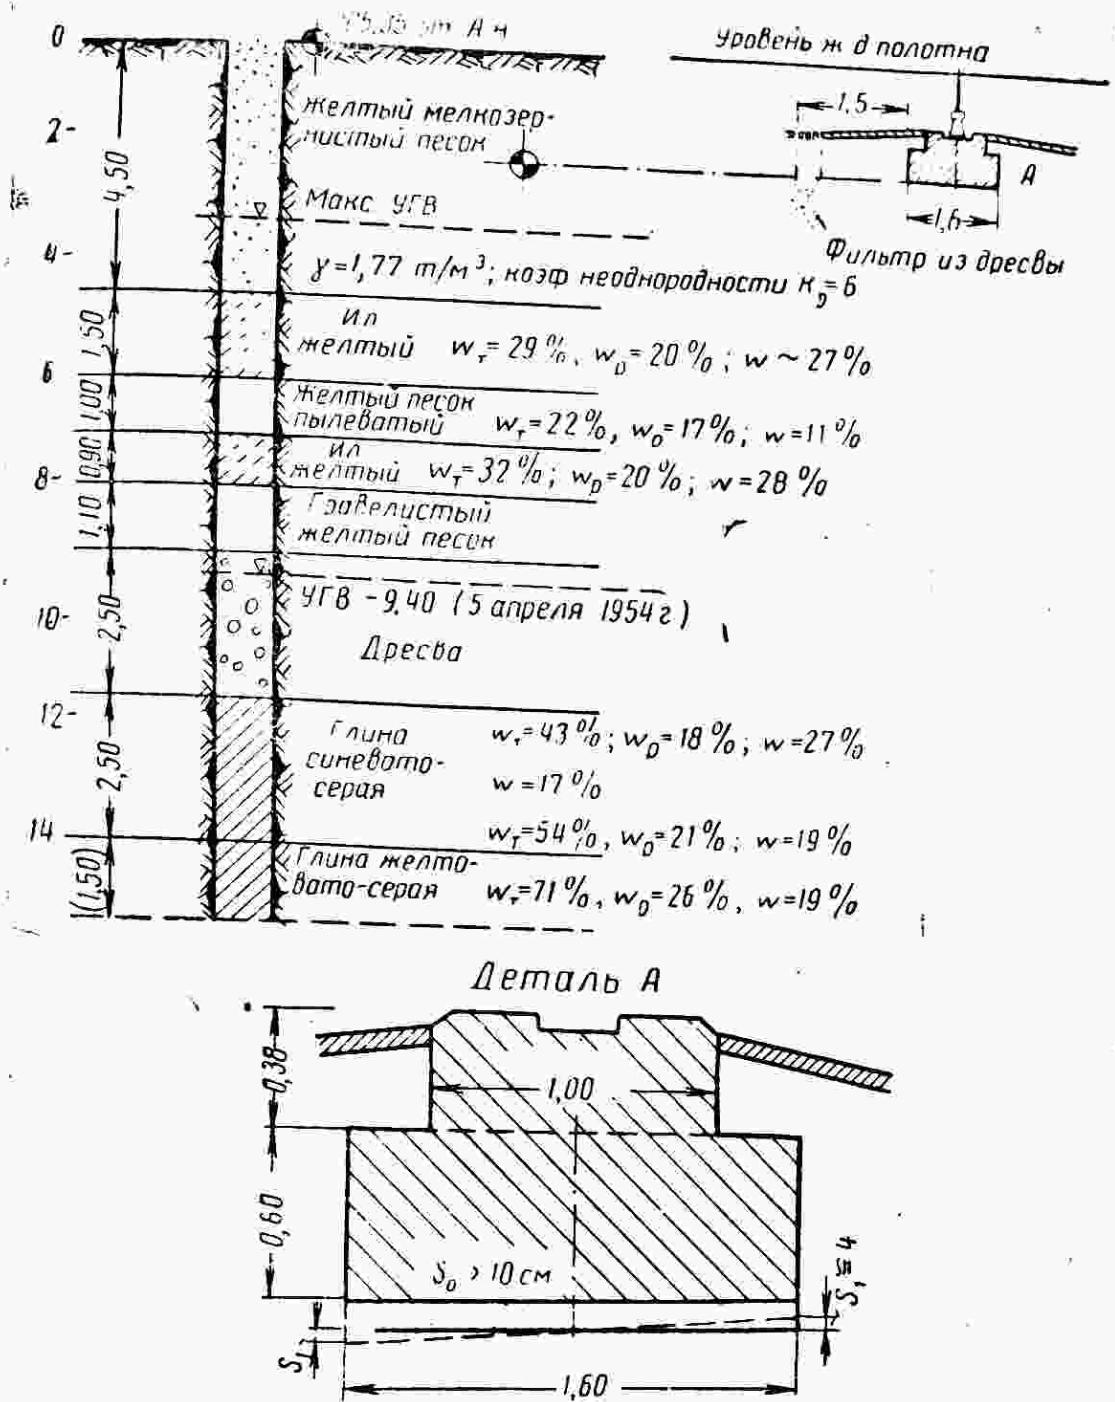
Наклон осевого блока поворотного круга на скотобойне
